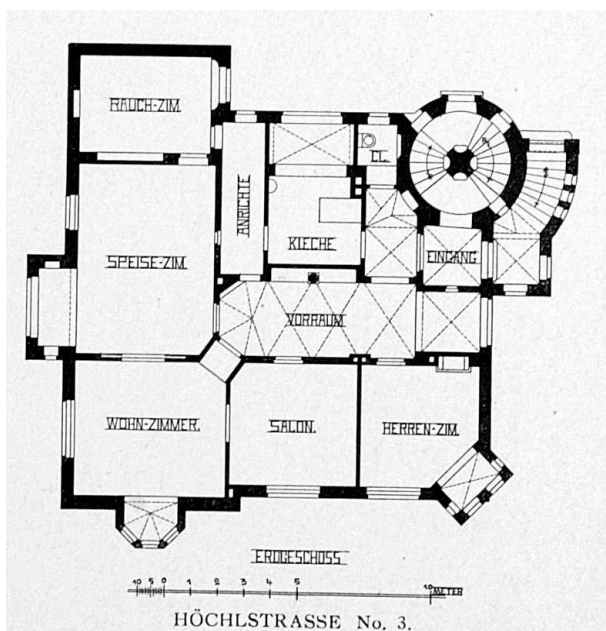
Villa Winklhofer, Grundriß Erdgeschoß, Plan nach Norden ausgerichtet, publiziert 1904.
